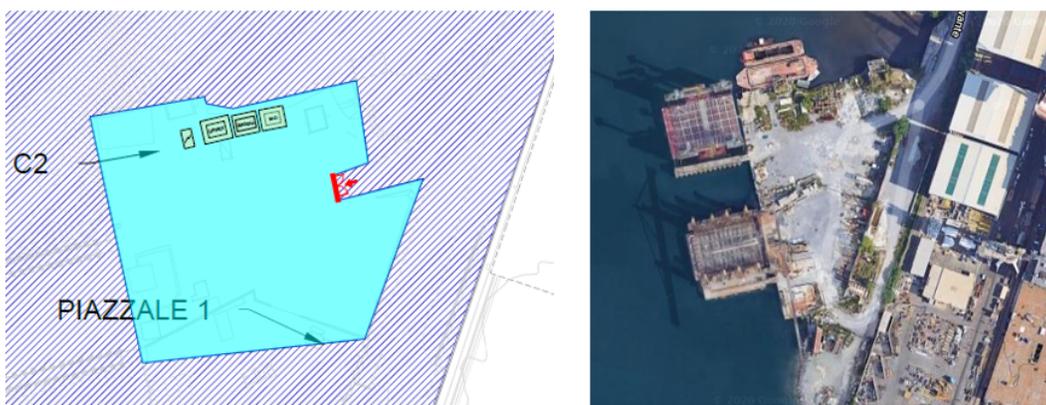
Area cantiere C2 – Layout di cantiere ed inquadramento territoriale
